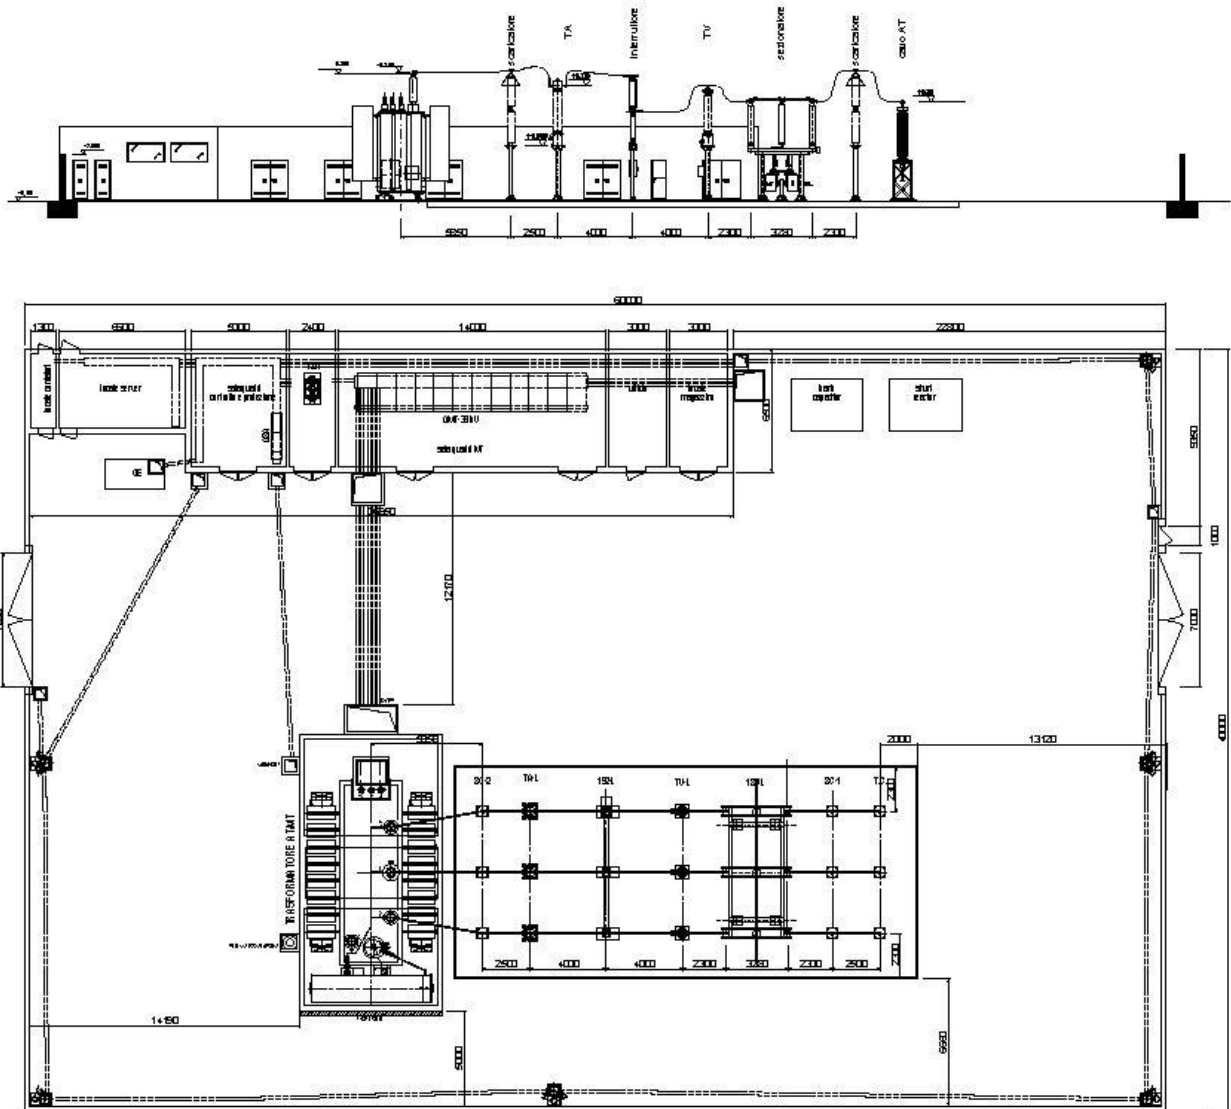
Pianta e sezione della cabina di trasformazione con ripartizione interna locali.
